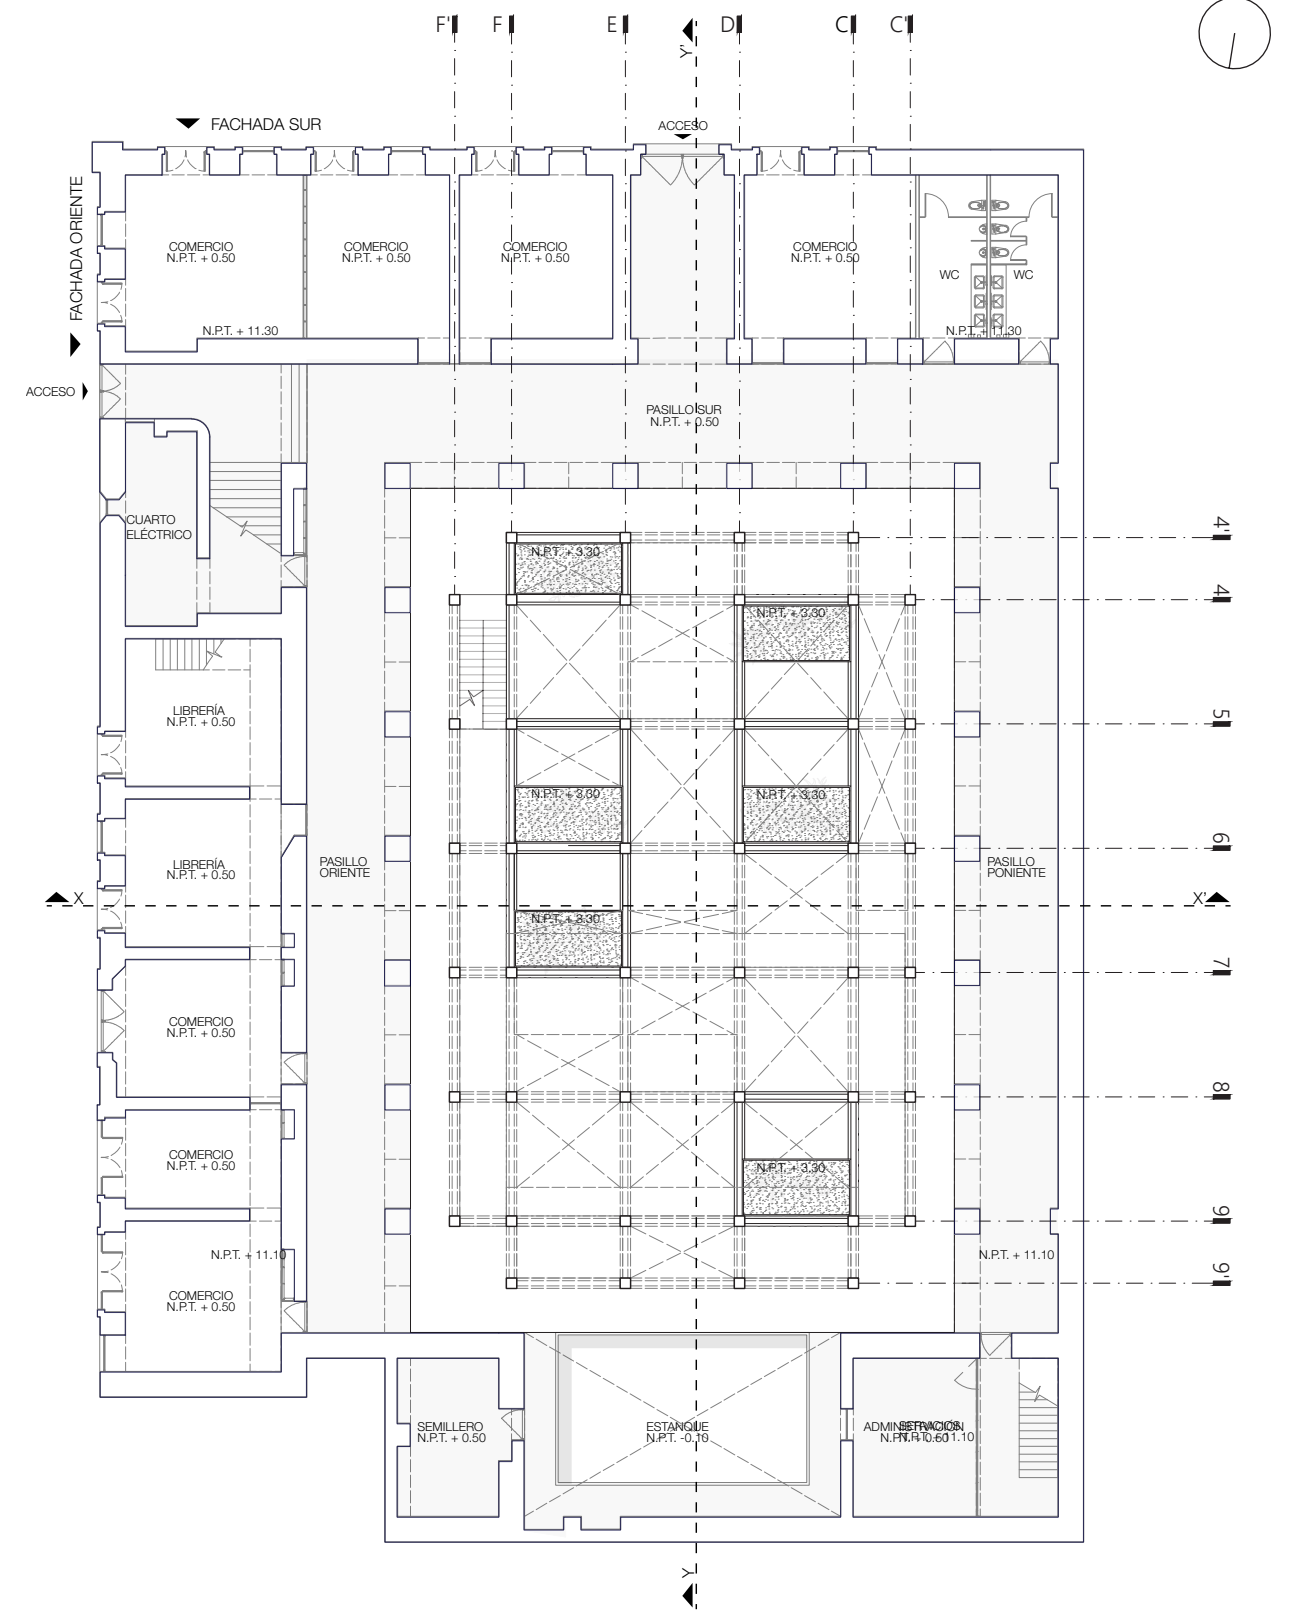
Planta arquitectónica nivel +3.30m. Fuente: Elaboración propia.
